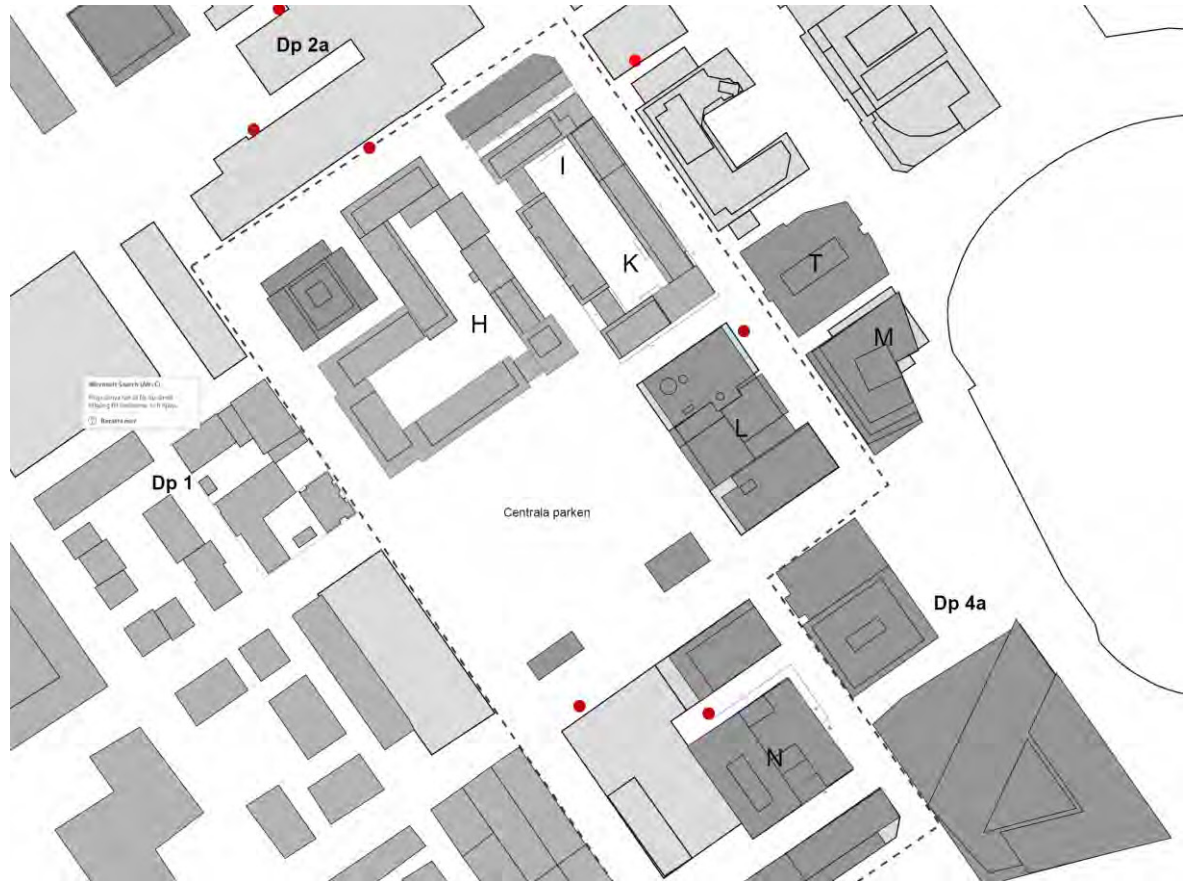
Externa bullerkällor fullt utbyggd plan. Bullerkällor markeras med röda punkter.
